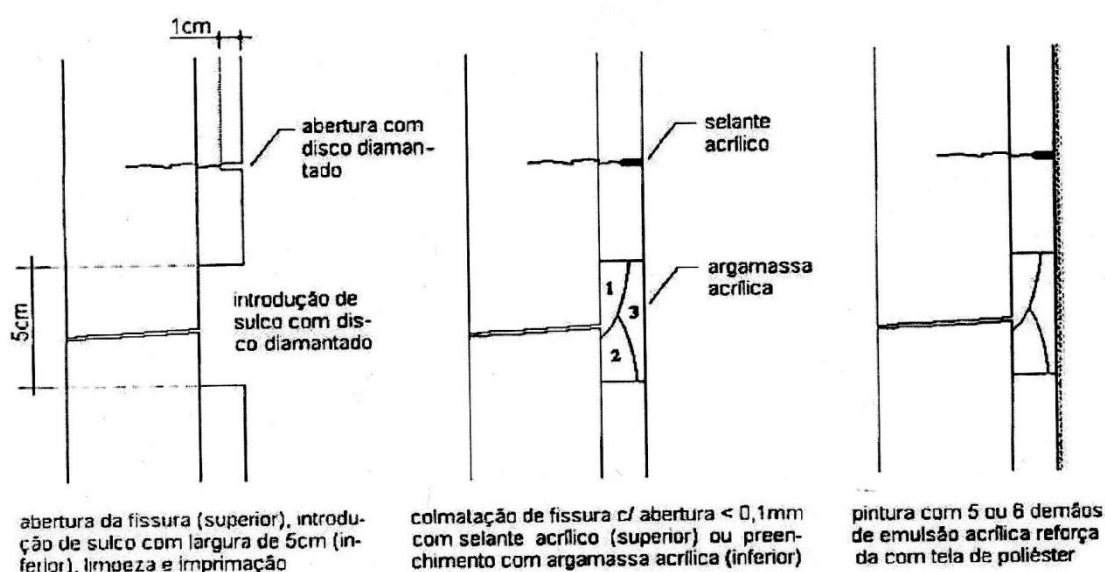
Recuperação de fissuras e destacamentos nas fachadas, com selante acrílico (aberturas reduzidas) ou argamassa acrílica (aberturas pronunciadas) (IPT, 2007).
